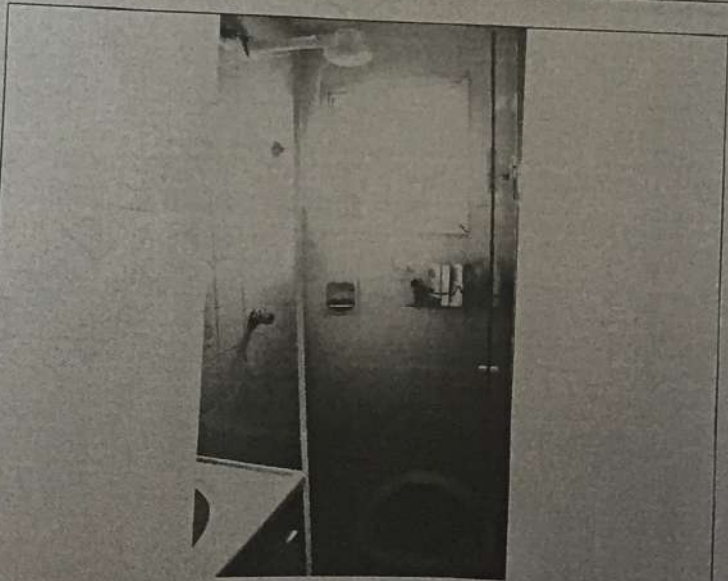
Detalhe vista do Banheiro do Apartamento Nº 146. Nota-se seu estado de conservação e os diversos materiais de acabamento e construção.
